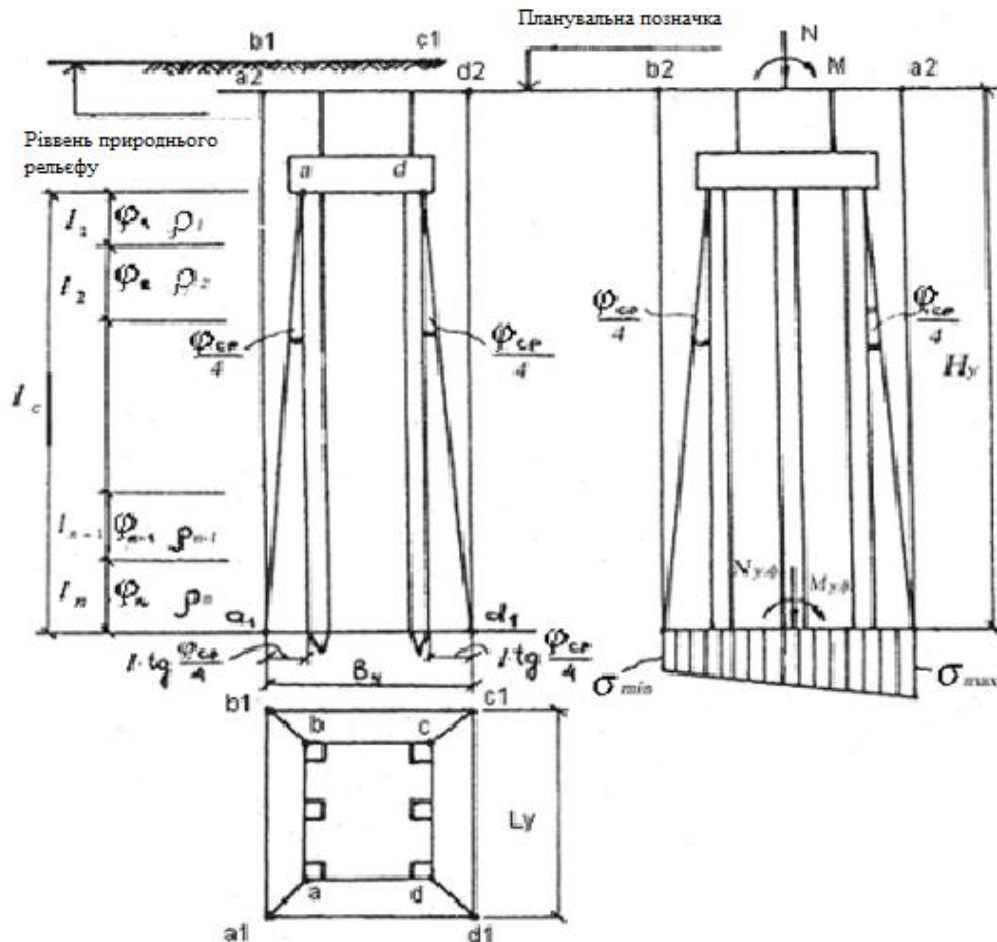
Схема визначення розмірів ґрунто-пального масиву (умовного фундаменту) для розрахунку осідань куцого пального фундаменту
